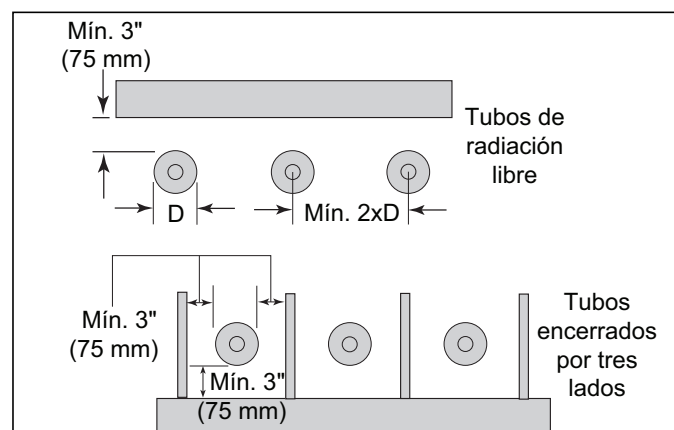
Ejemplo de dimensionamiento del quemador SER
